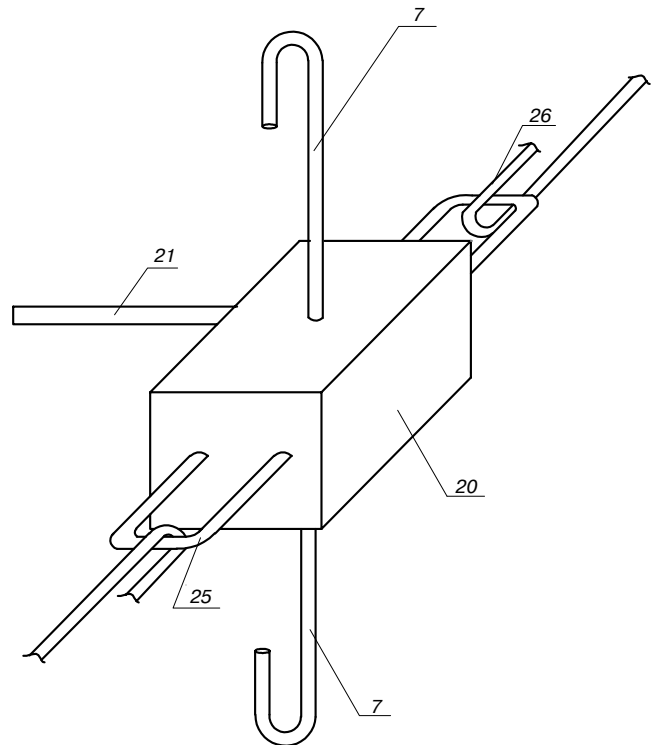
Отдельный мелкий бетонный блок сборно-монолитного обвязочного пояса
